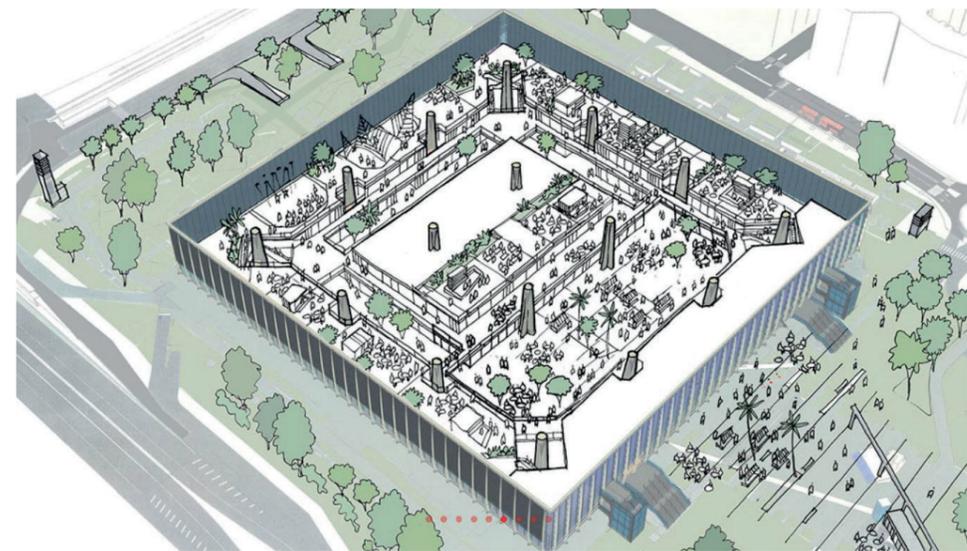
Il Progetto del Centro Commerciale, Planimetria di Progetto, Studio Rolla, 2016
